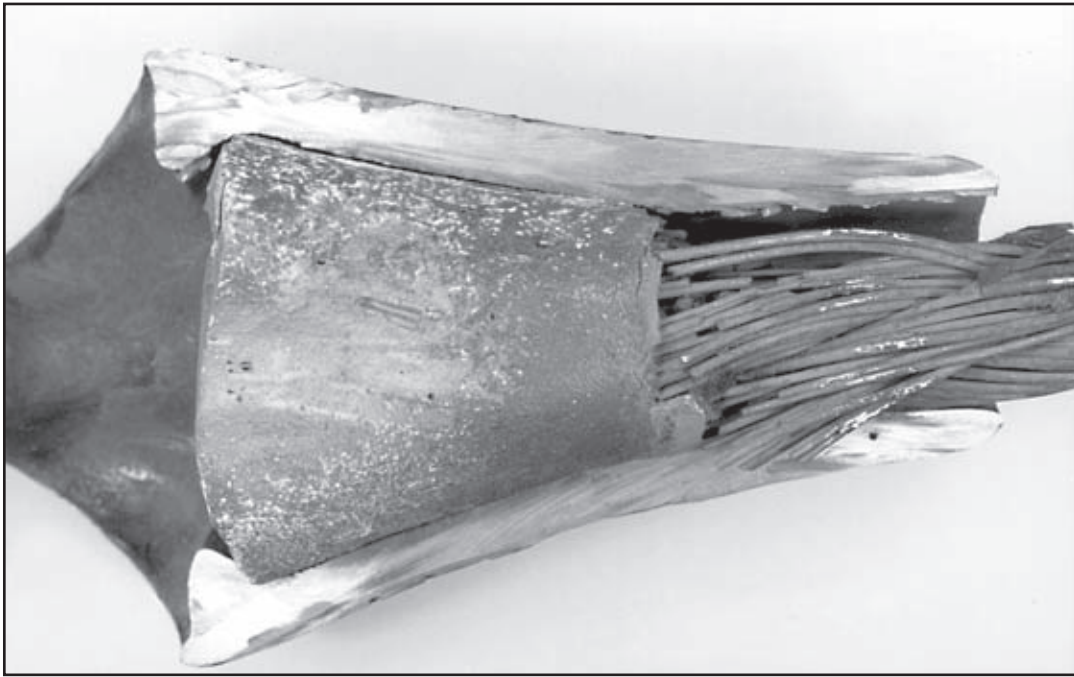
Korrosion und Drahtbrüche am Birnenaustritt
